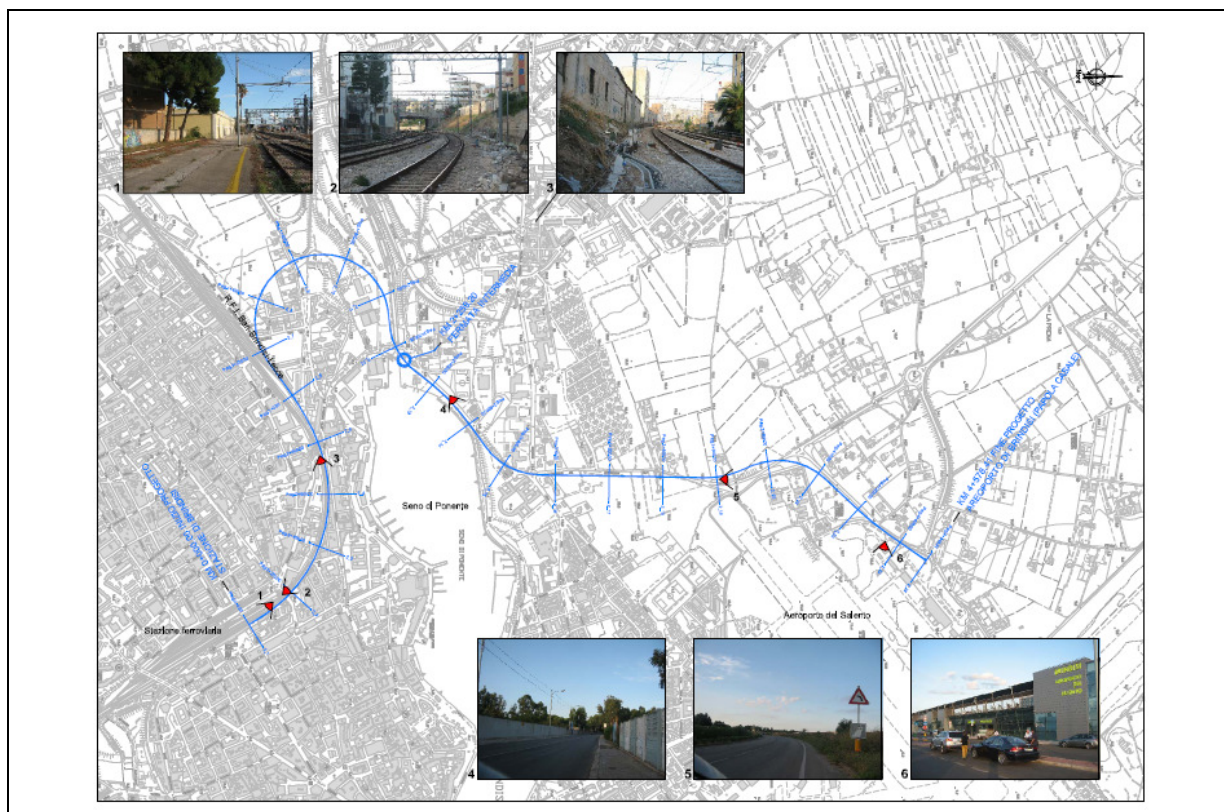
Collegamento Stazione – Aeroporto – Ipotesi 2 PDM
